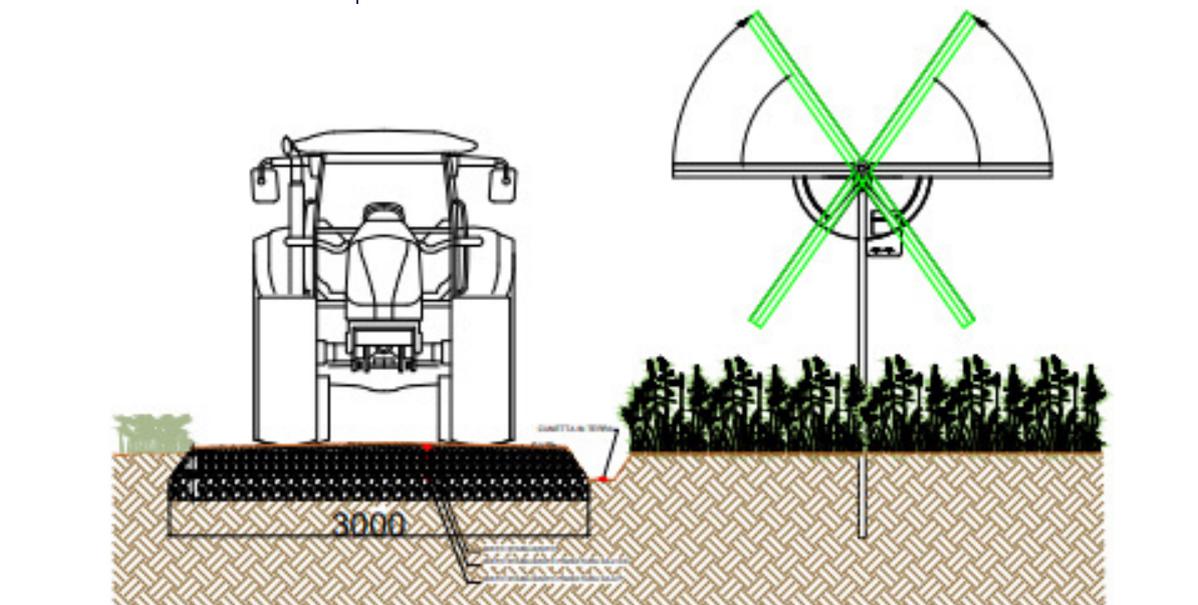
Tipico sezione viabilità e cunetta drenaggio laterale
